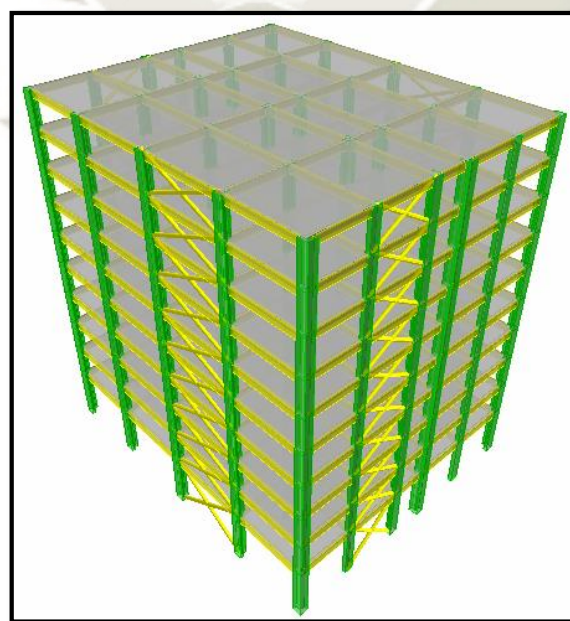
Modelo estructural del Sistema de Pórticos de concreto armado arriostrados realizado en el programa computacional ETABS 9.7.4. (Fuente: Elaboración propia)
